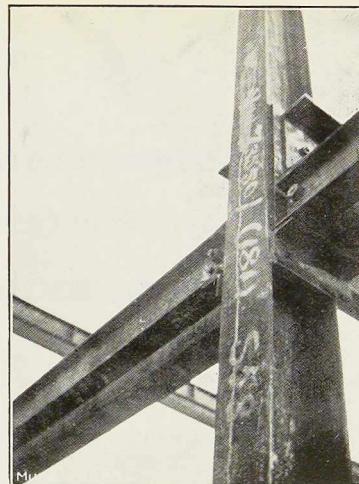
Assemblage d'un poteau nord avec une entretoise et les poutres porte-murs.
